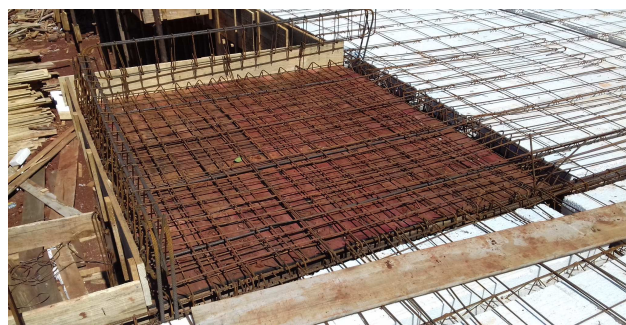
Preparo de armaduras longitudinais positivas e negativas na laje L1
